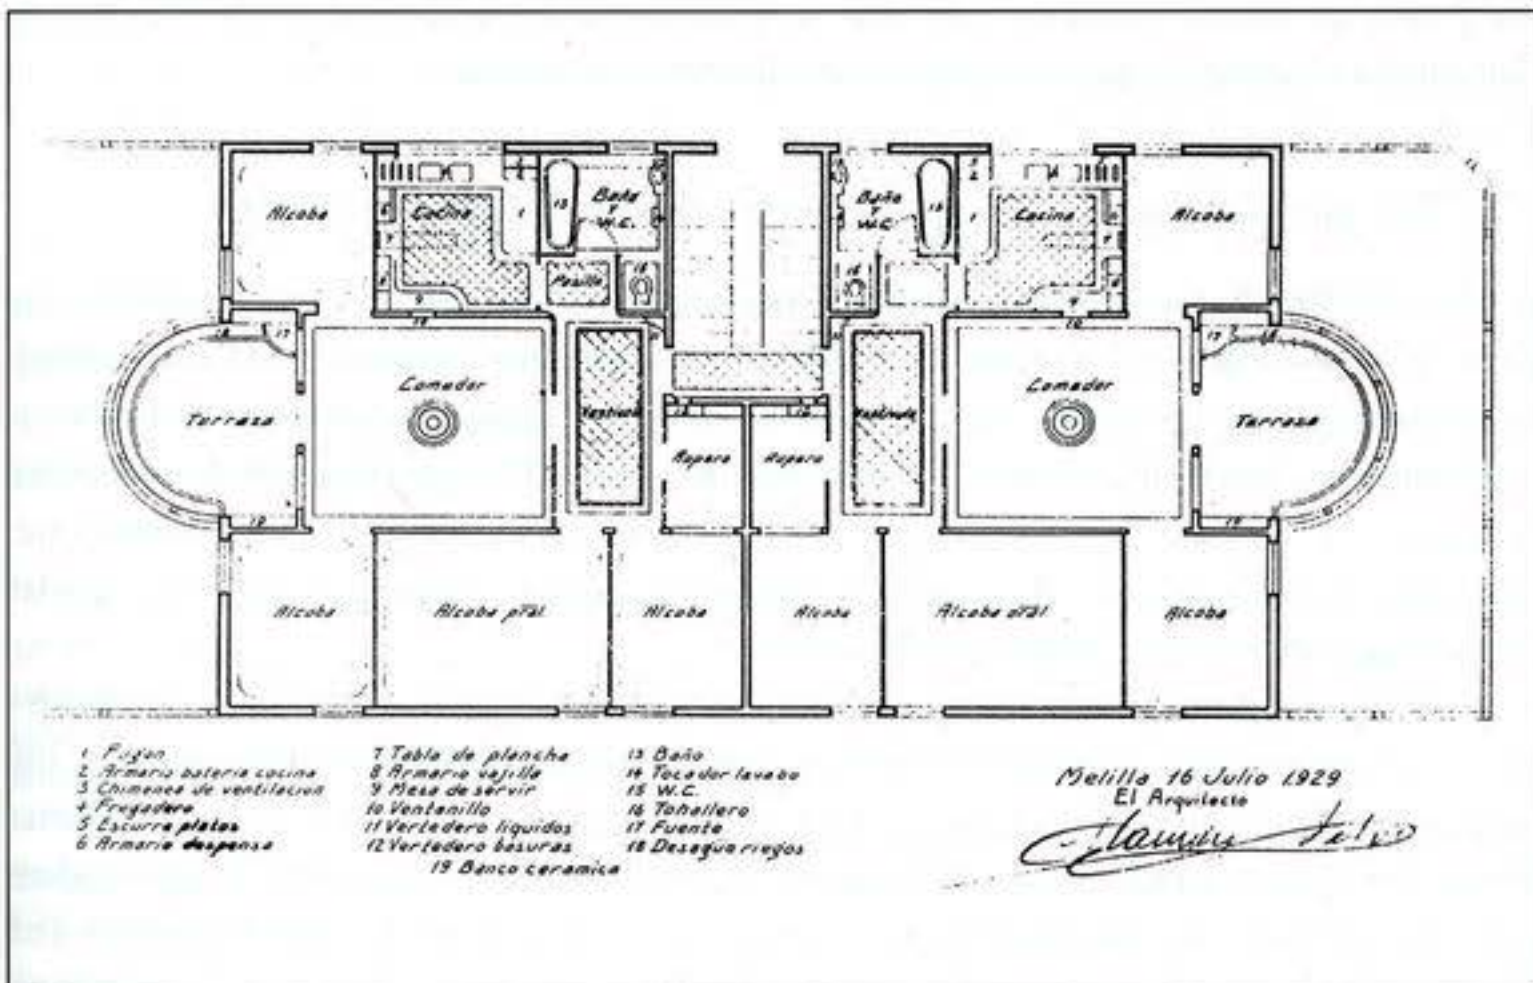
Mauricio Jalvo. Planta de un proyecto de casas para maestros, 1929. AMML.OPC.14-5-3-1.
